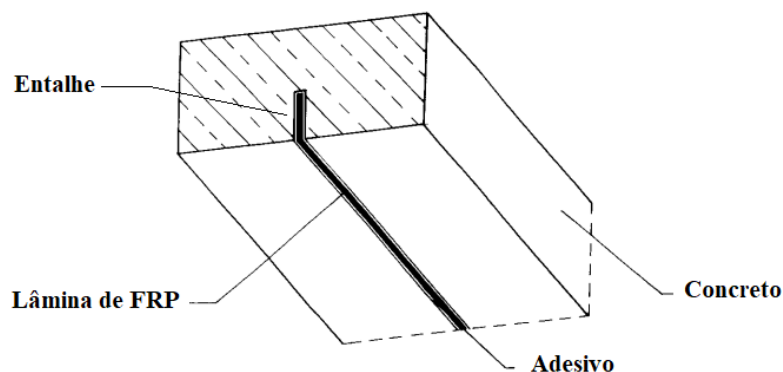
Reforço estrutural com FRP colado no interior de entalhes na camada de concreto de recobrimento das armaduras (NSM), adaptado do Bulletin *fib* 14 (2001).
